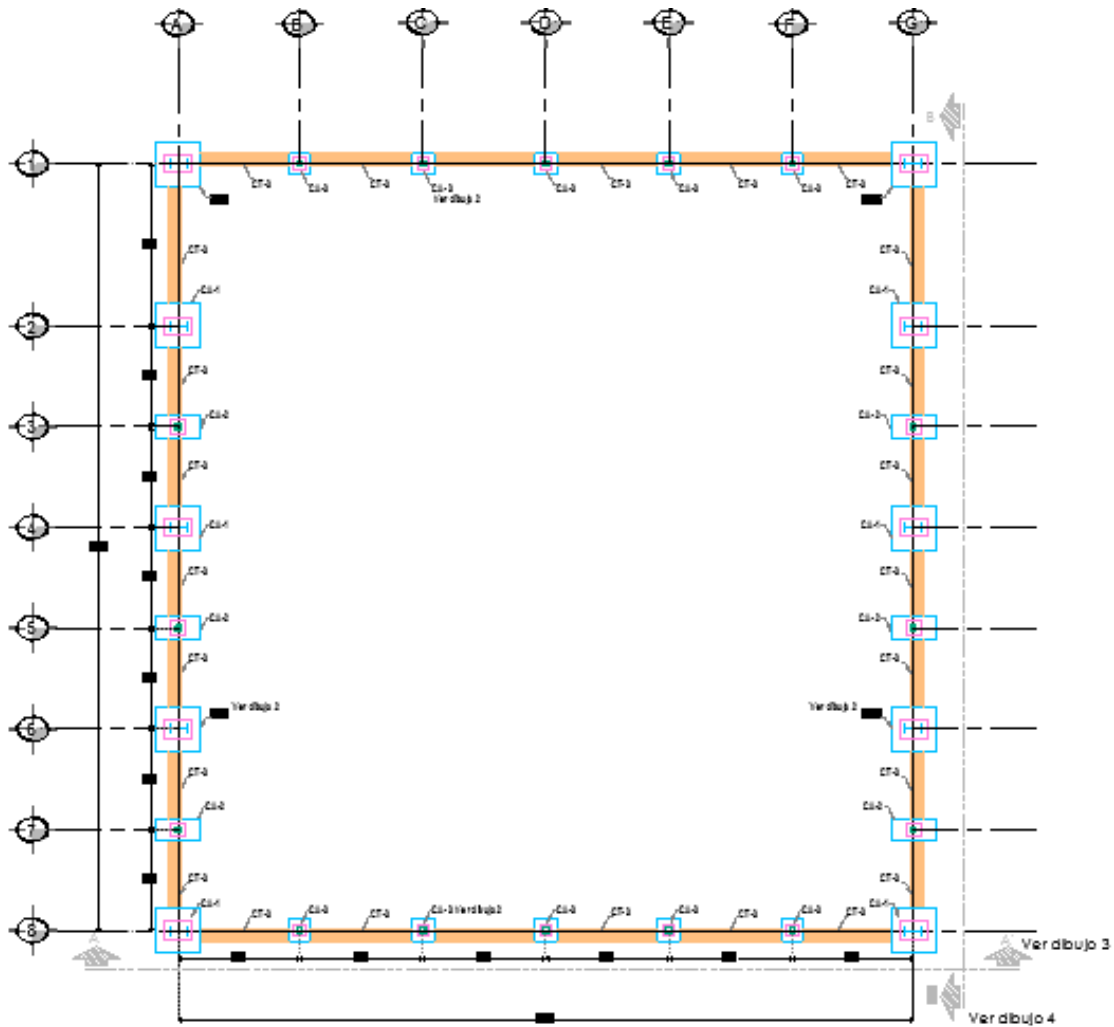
Cimentación para casa de máquinas (Vista en planta)
